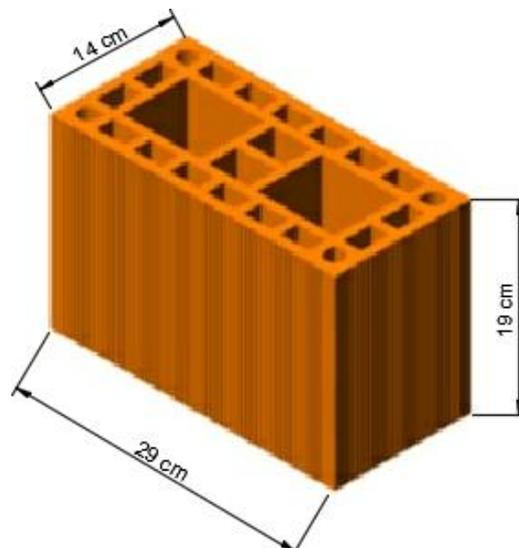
Bloco estrutural cerâmico utilizado nas paredes da HIS Residencial Luna.
